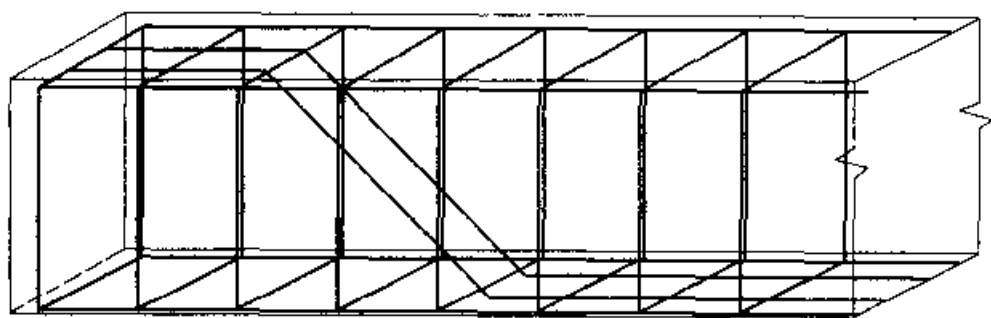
钢筋混凝土简支梁的钢筋骨架
